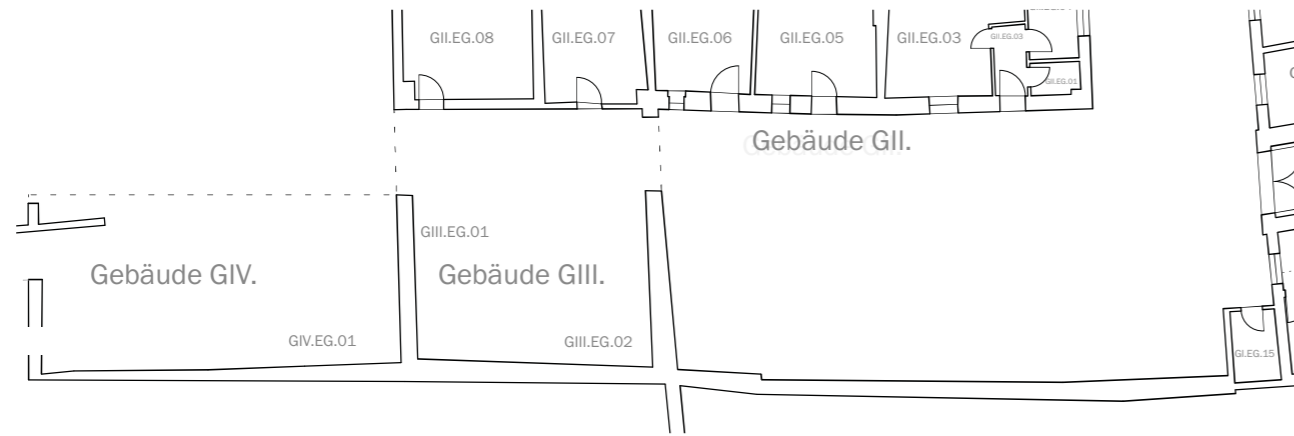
Grundriss Gebäude GIV. 1:250
